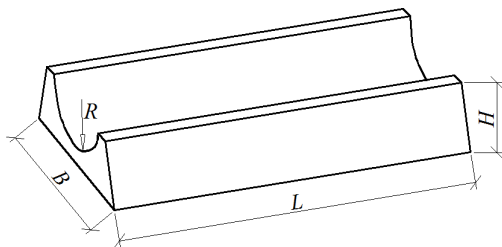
Лекальный блок для железобетонной безнапорной раструбной трубы
